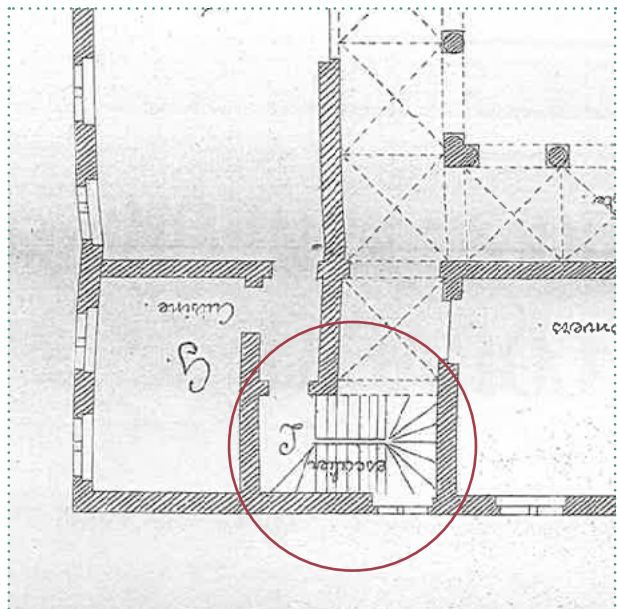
Plans du rez-de-chaussée de la tourelle d'escalier selon différentes sources :
